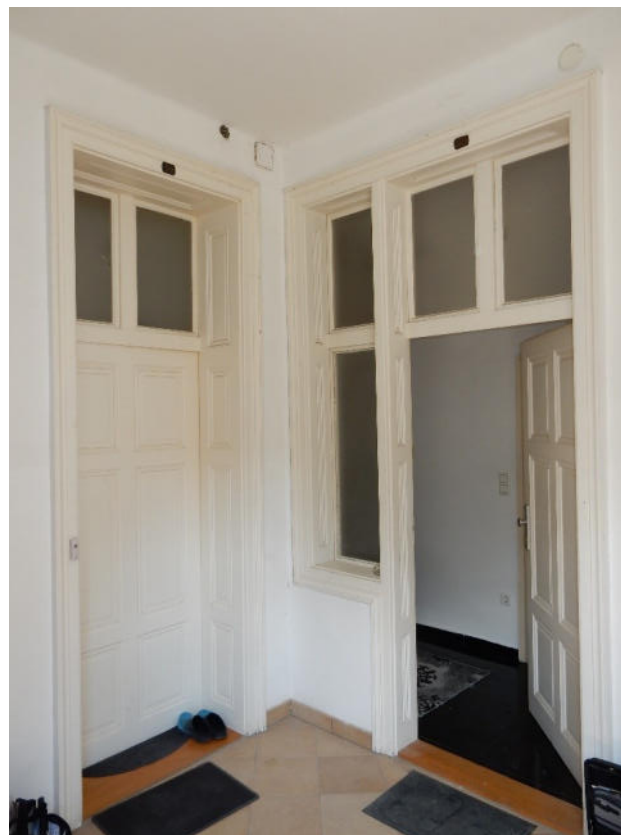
Eingänge zu den Wohnungen 9 und 10 im 1. Stock
